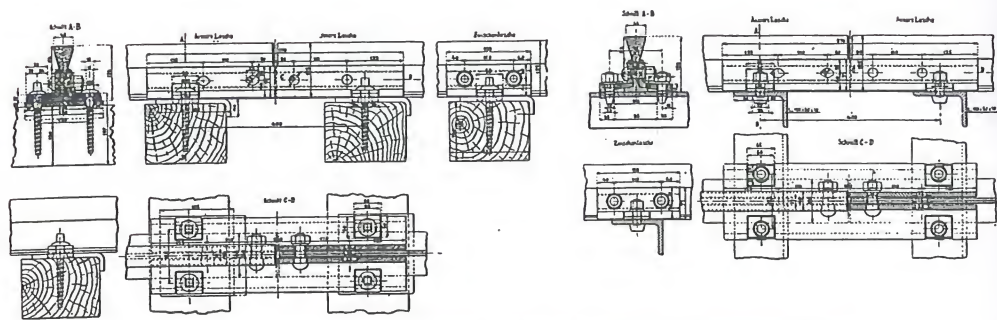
Oberbau mit hölzernen und mit eisernen Querschwellen.
